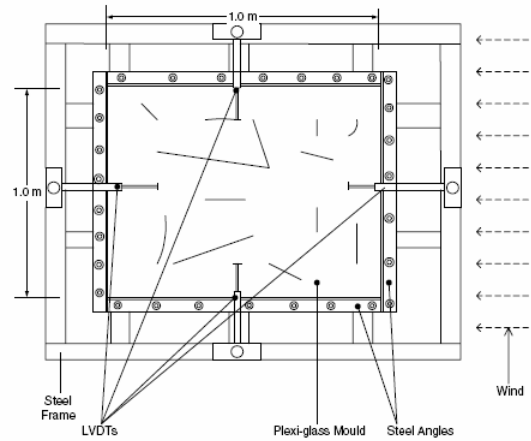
Fissuration précoce d'une dalle de béton soumis au séchage au très jeune âge.
